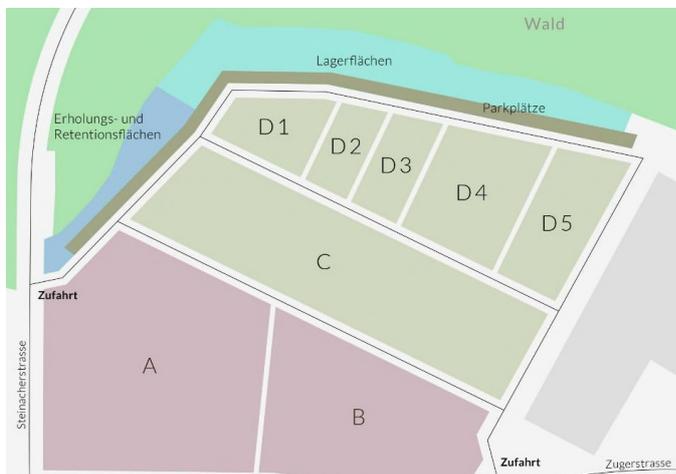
Areal Werkstadt Zürisee, Baufelder A, B, C, D1-D5 und Nebenflächen
